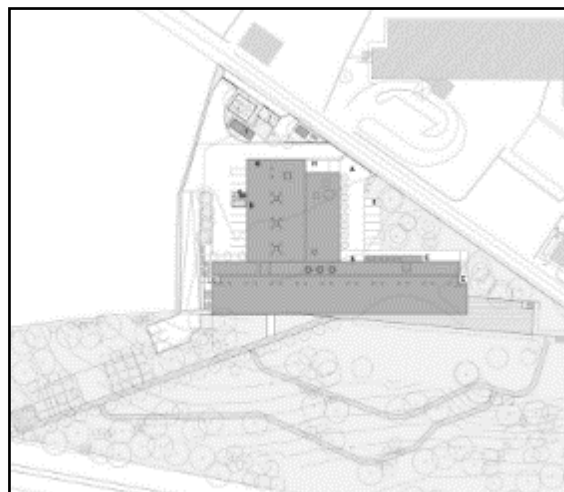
VISTA EN PLANTA DEL CENTRO DE RESIDENCIA TORRE SENIOR
